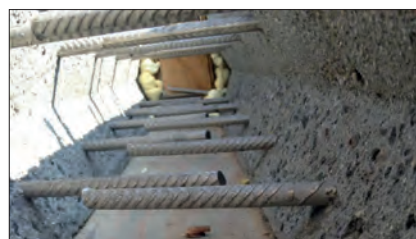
D juntas longitudinales y transversales entre paneles a rellenar con UHPC.
